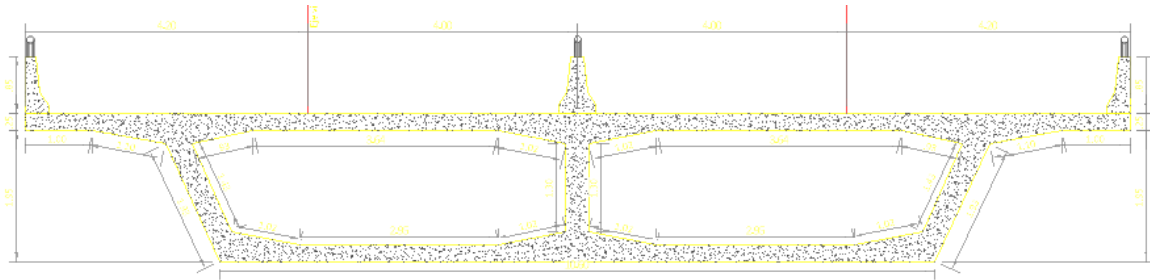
Sección transversal superestructura puente caso de estudio 2.
